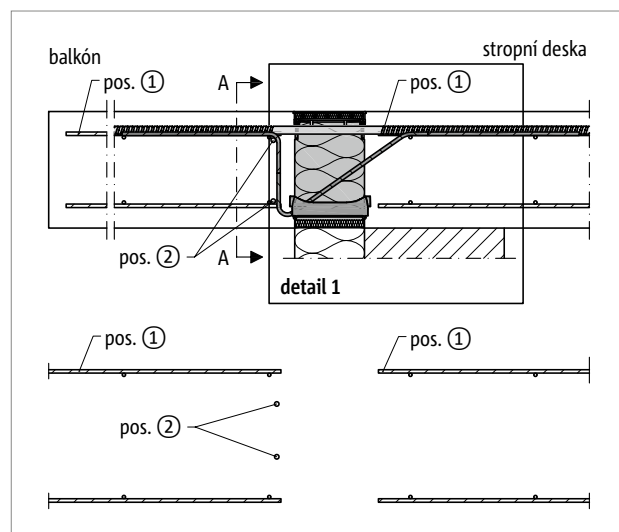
Schöck Isokorb® CXT typ KL-M7-VV1: Půdorys prvku
